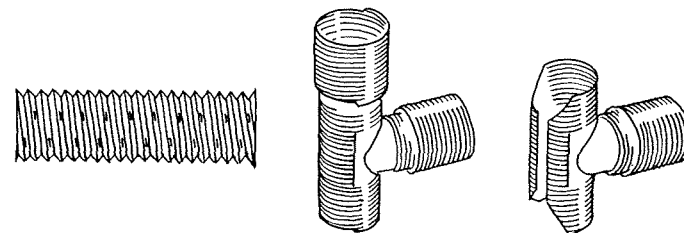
Korrugerede PVC-rør til dræning. Grenrørstyper.
